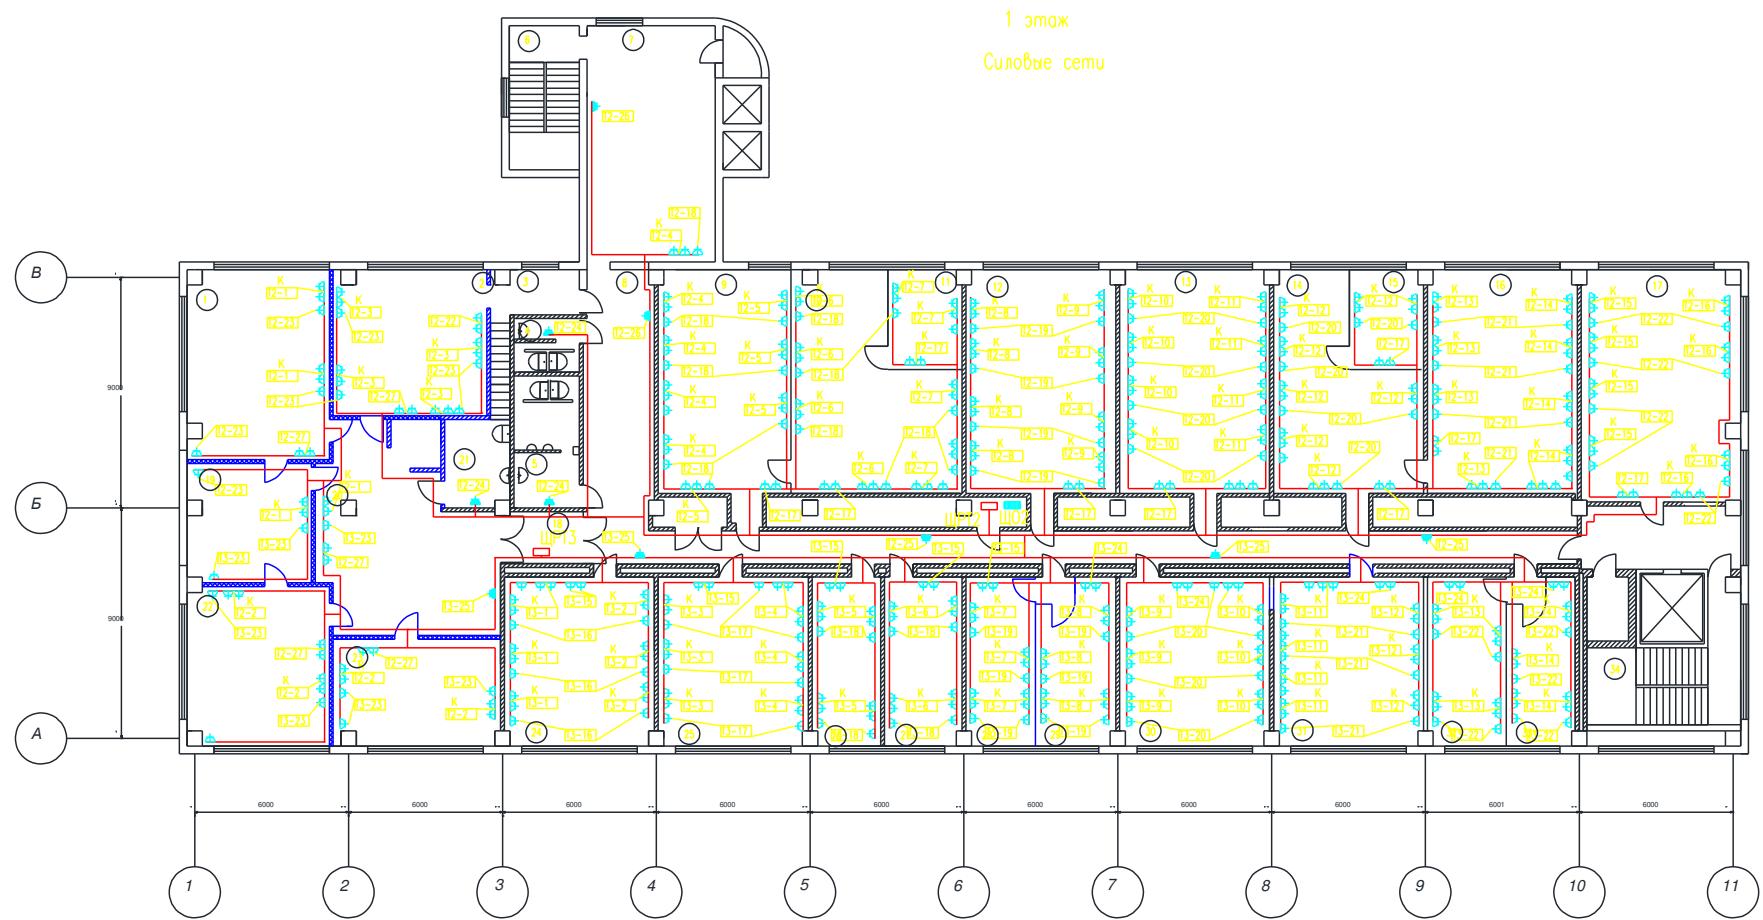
План силовых сетей 1-го этажа административного здания
